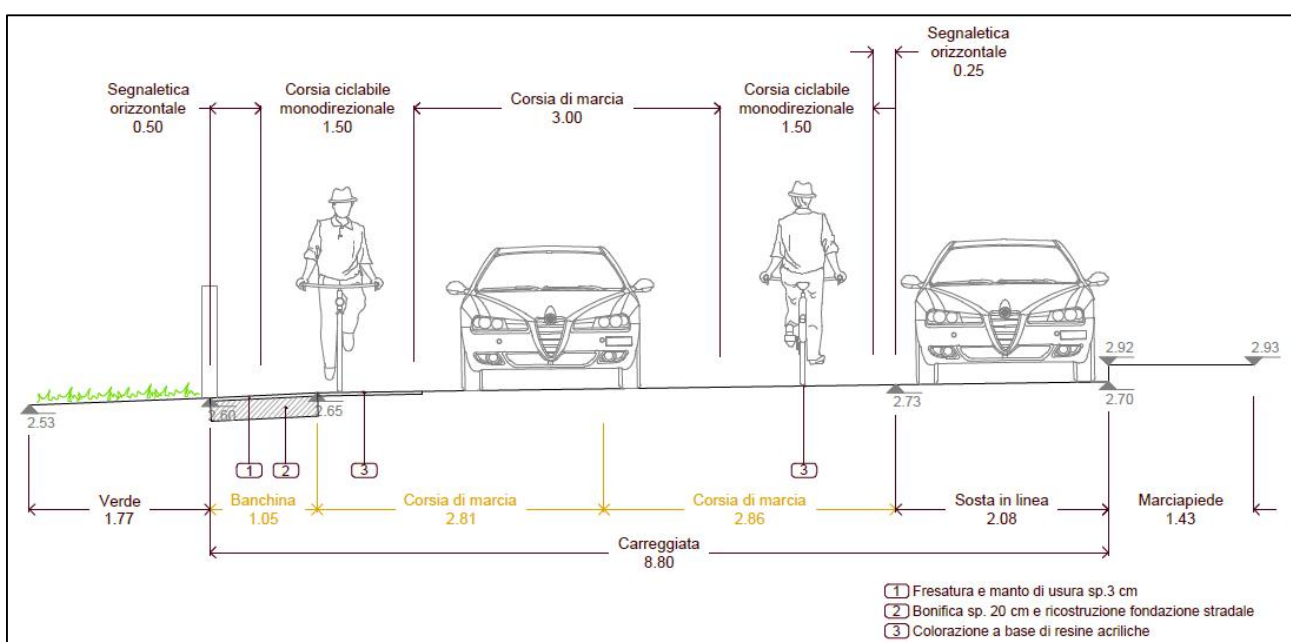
Sezione 01 di progetto trasversale su Viale Italia
